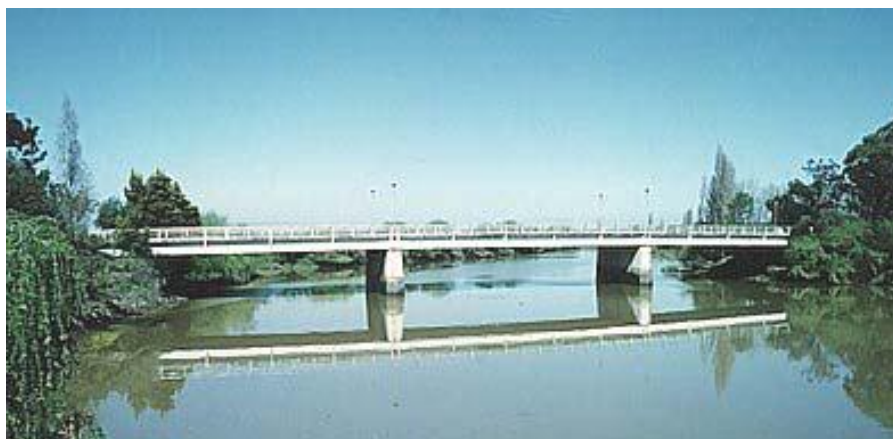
Ponte de Vala Nova, Benavente. Primeira ponte construída com betão armado pré-esforçado. [SETH; s.d.]
